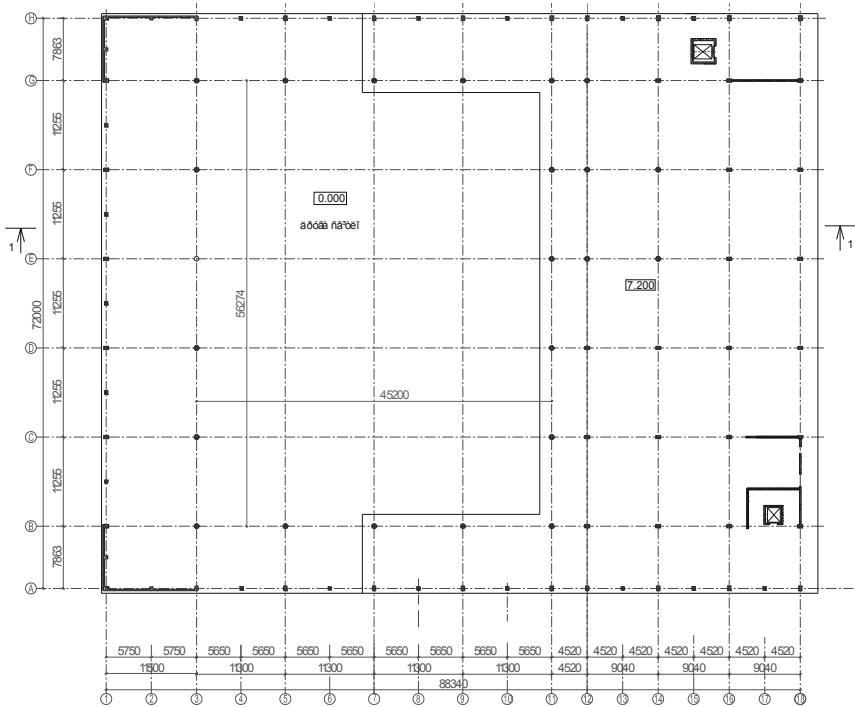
Схема розташування вертикальних несучих елементів будівлі в рівні третього поверху
